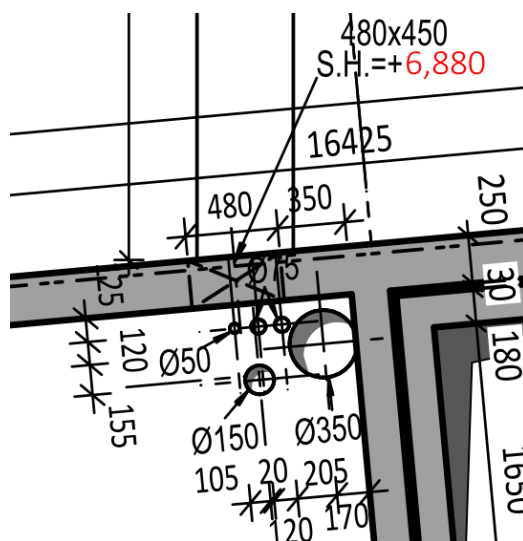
Otvor pro vedení kanalizačního potrubí v ŽB stěně - staticko-konstrukční řešení
